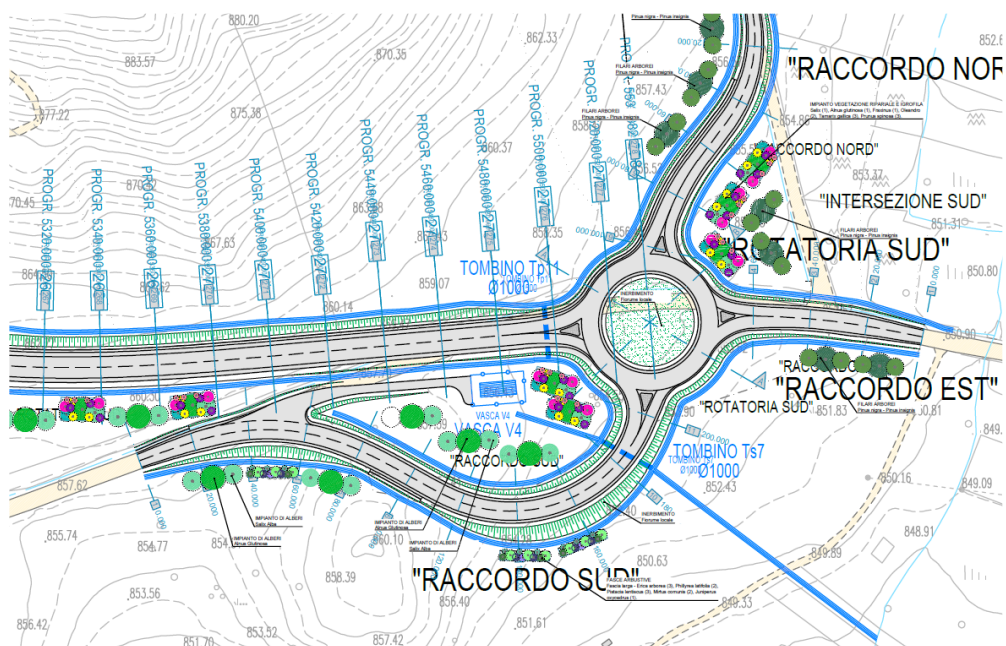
vista del tracciato, intersezione sud – opere di mitigazione
